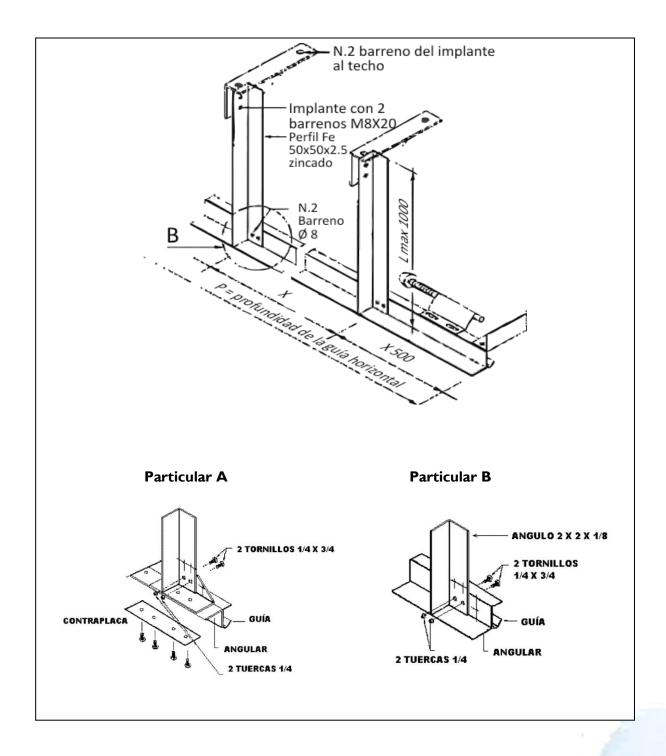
C Anclaje de las guías horizontales a techo PBI (Standard Lift) Enganche Techo Para Guía TIPO 2
